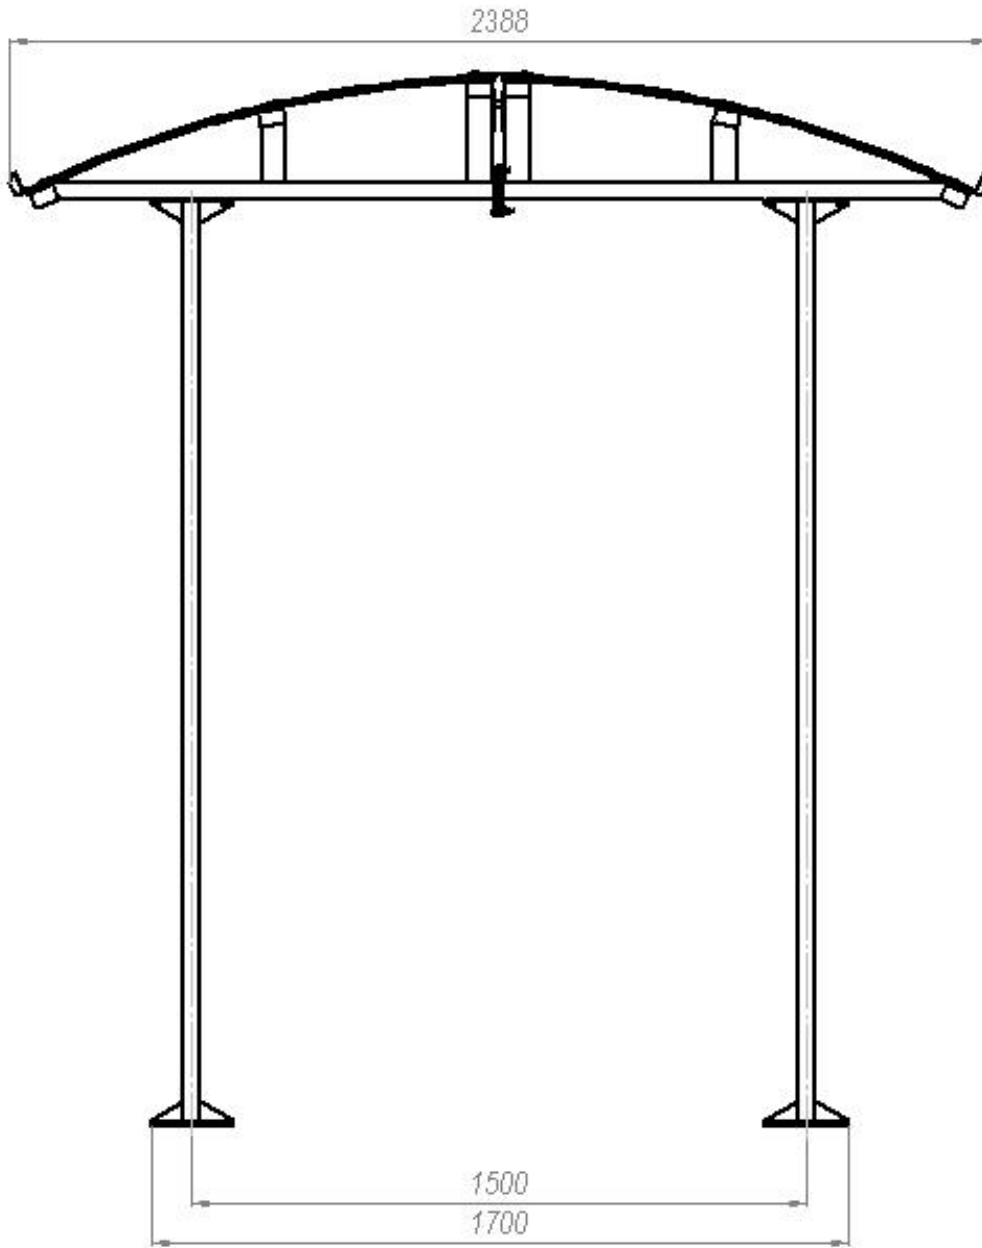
(а) – Габаритные размеры крыши (вид с торца)
